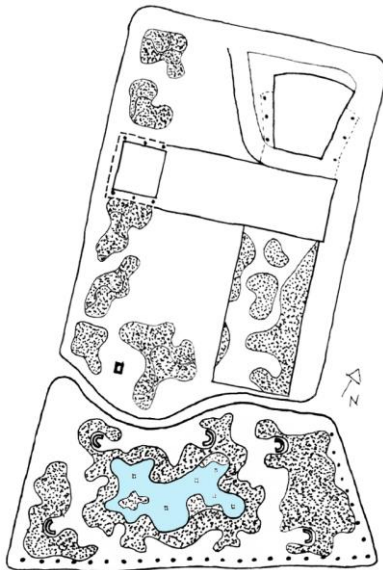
Esquema de todo el conjunto en la planta baja del MES, con la propuesta para el terreno anexo.
